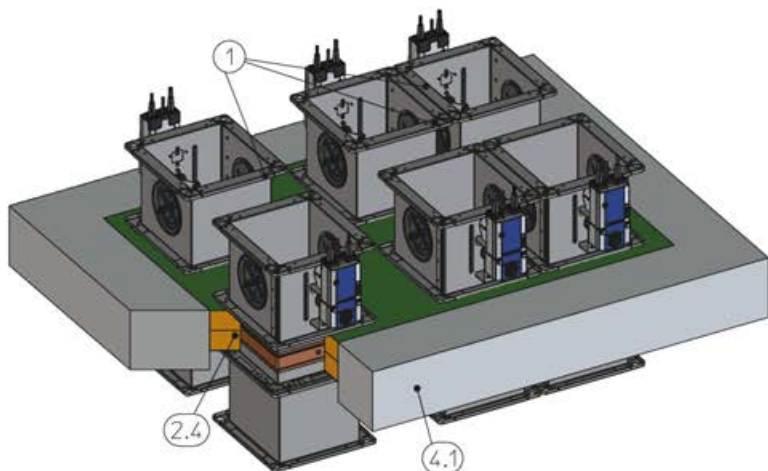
Installazione a secco in un soffitto a soletta piena, flangia a flangia, l'illustrazione mostra l'installazione verticale (vale anche per l'installazione sospesa)
